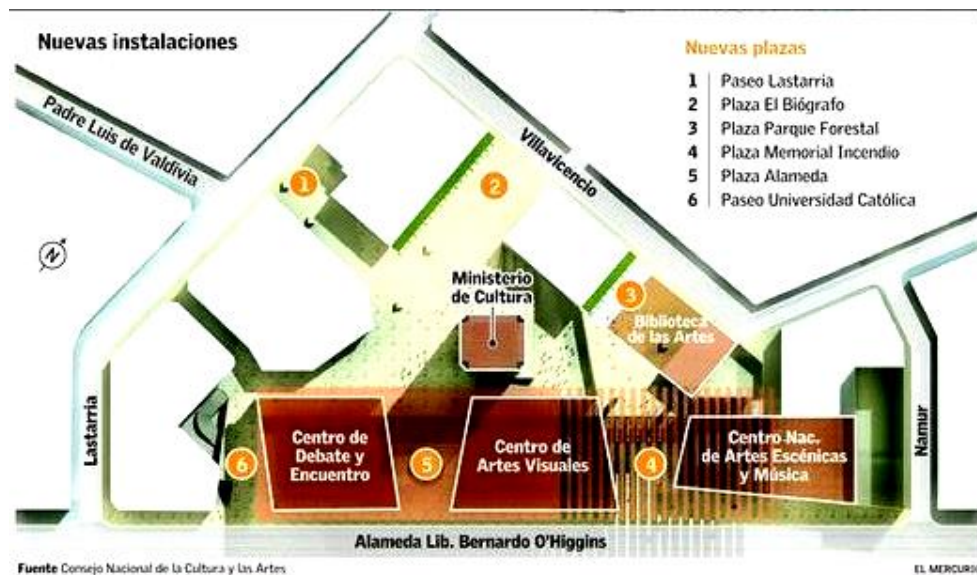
Planta esquemática del Parque biblioteca Gabriela Mistral.
